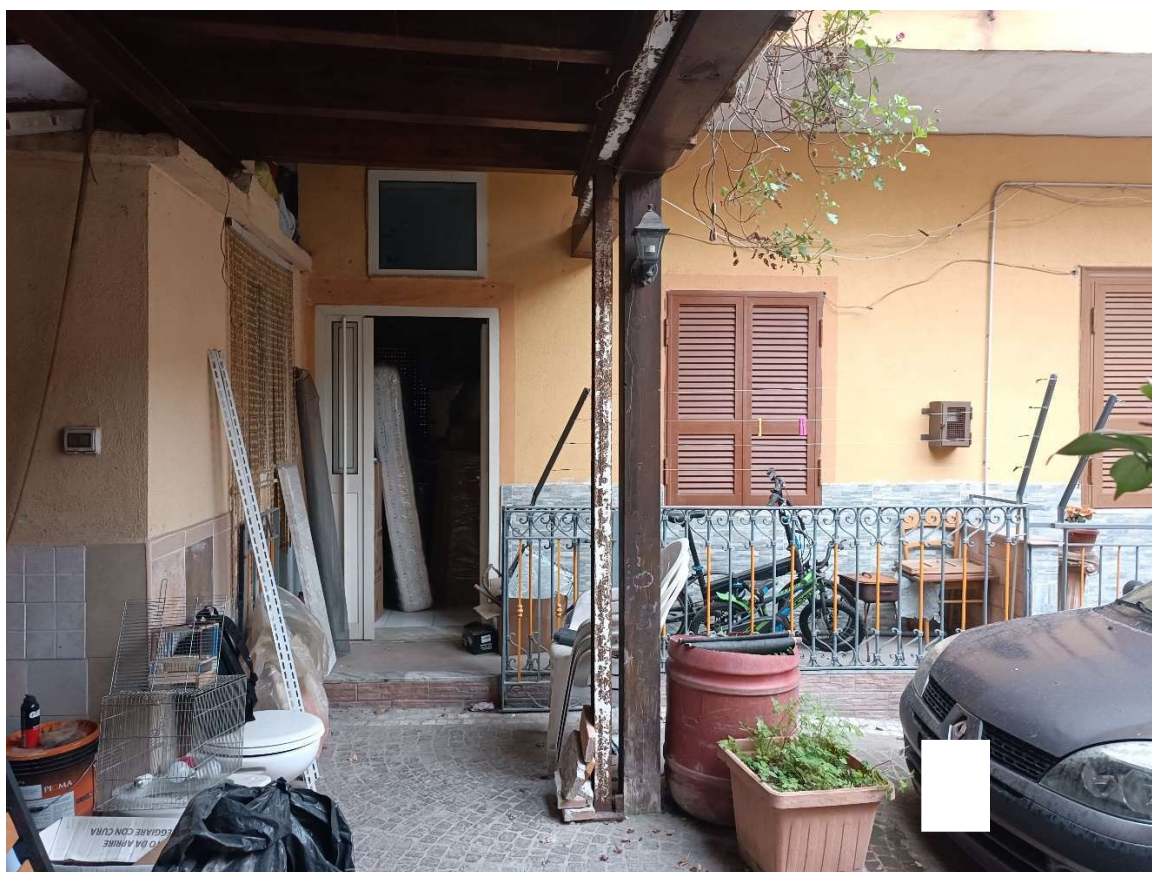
Vano deposito interno corte appartenente al lotto pignorato
